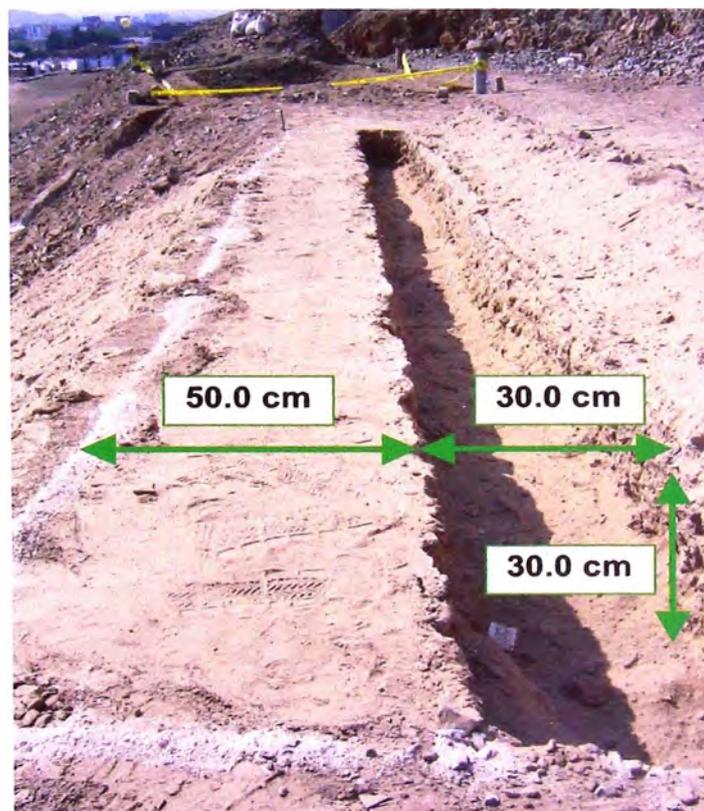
Zanja de anclaje para Parcela N° 01.
